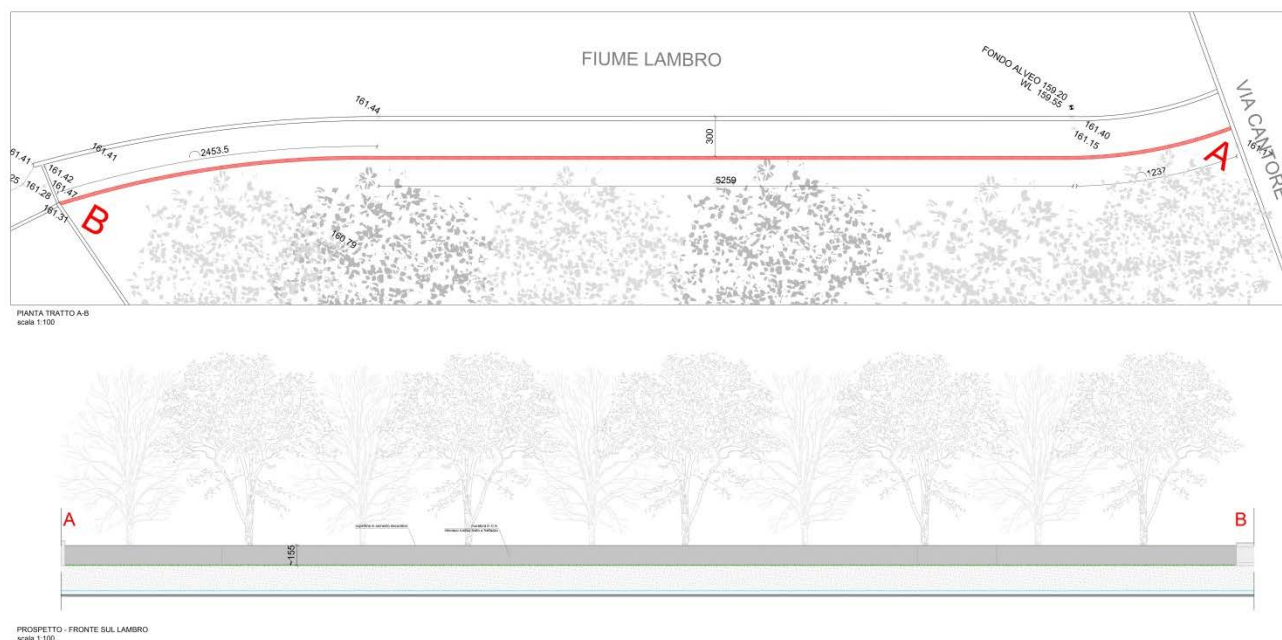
Pianta e prospetto del nuovo muro arginale verso il fiume Lambro
